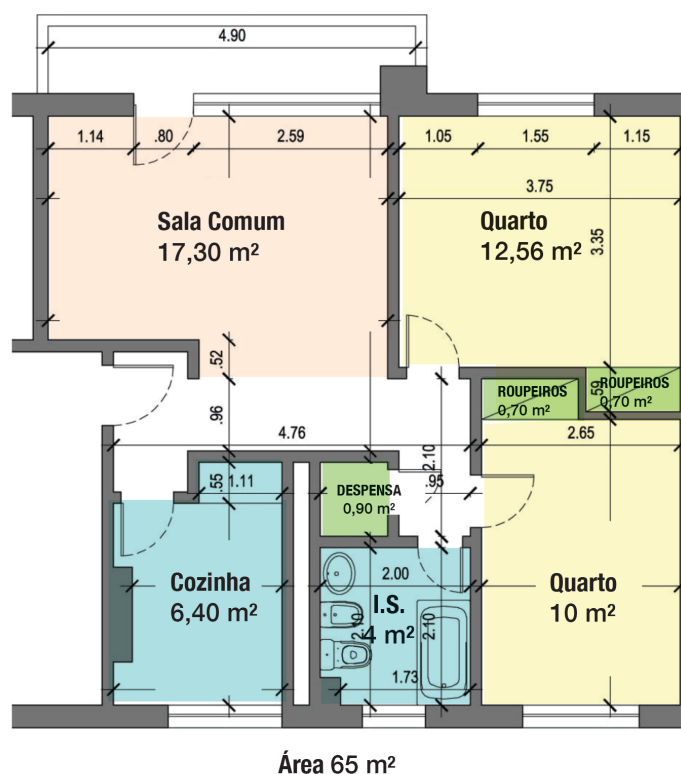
Planta e áreas de utilização T2 – planta sem alterações, imagem da autora
